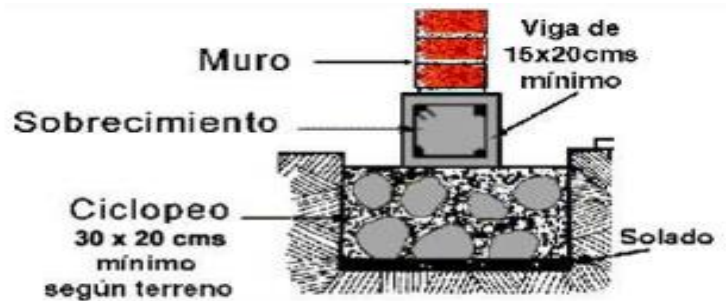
Esquema de muro en ciclópeo y viga de cimentación
